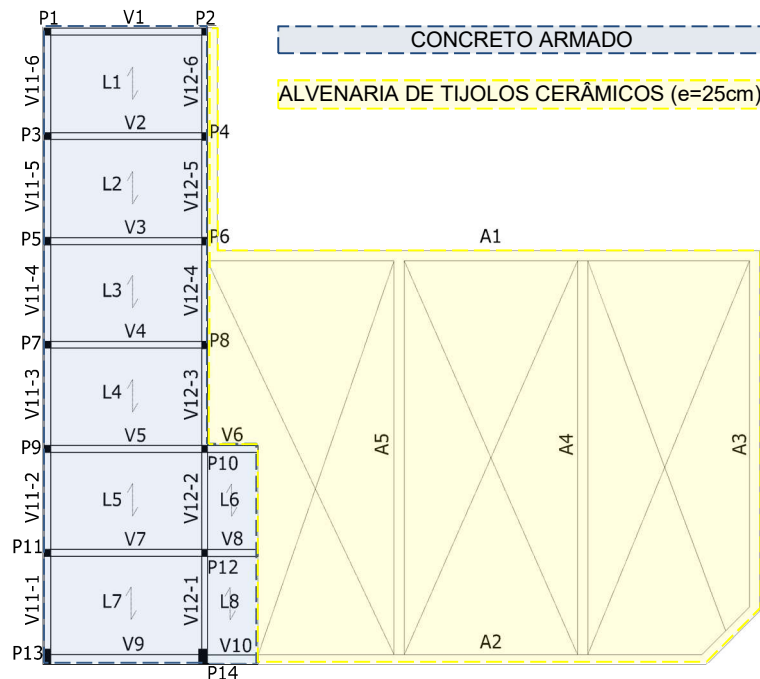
PLANTA DE TIPOLOGIA CONSTRUTIVA ORIGINAL
